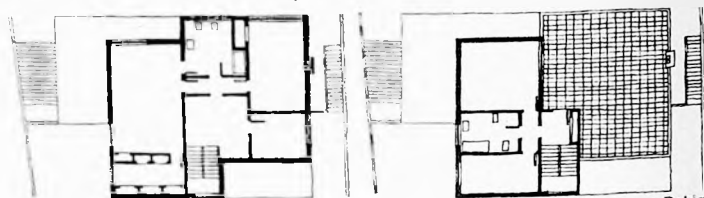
e 398 Planta primeiro e segundo pavimento casa rua Bahia.
